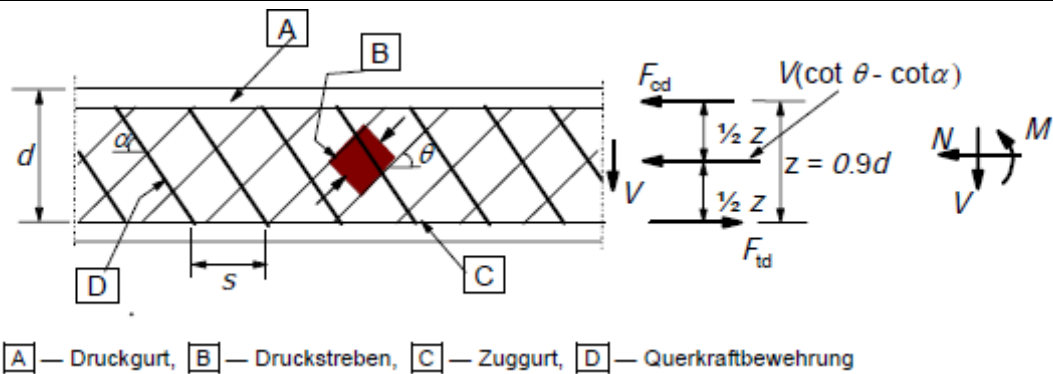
Fachwerkmodell für Bauteile mit Querkraftbewehrung laut EN 1992-1-1 [7]
